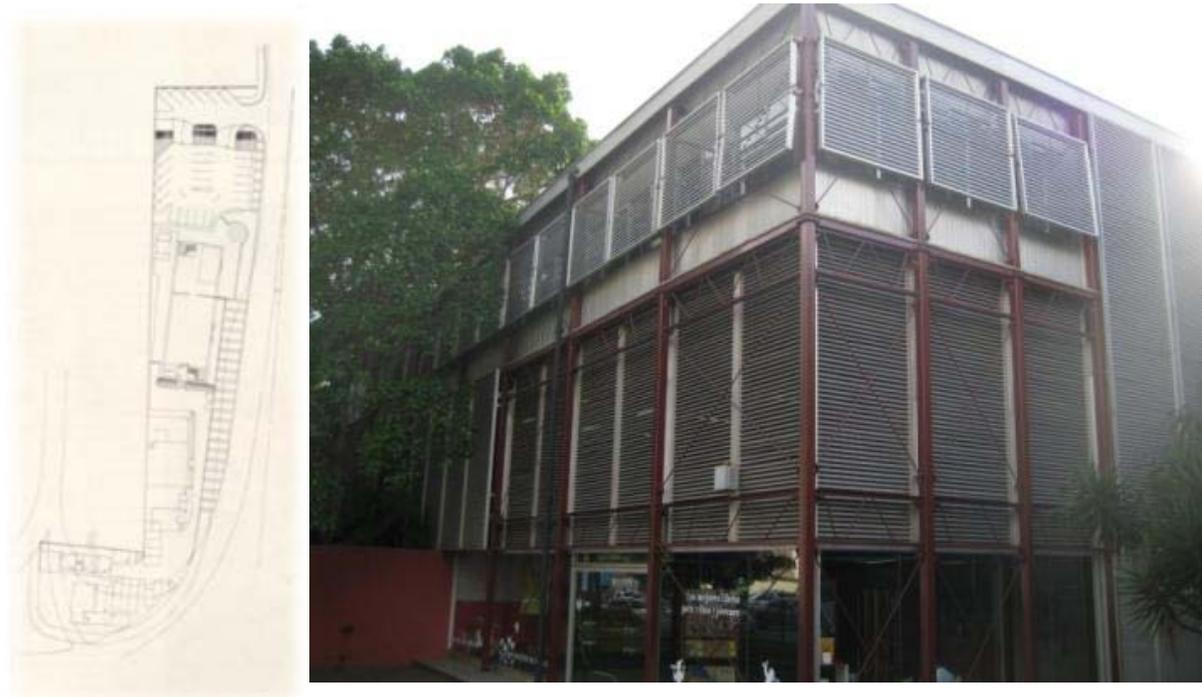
Planta (s/e) y foto fachadas norte y este
